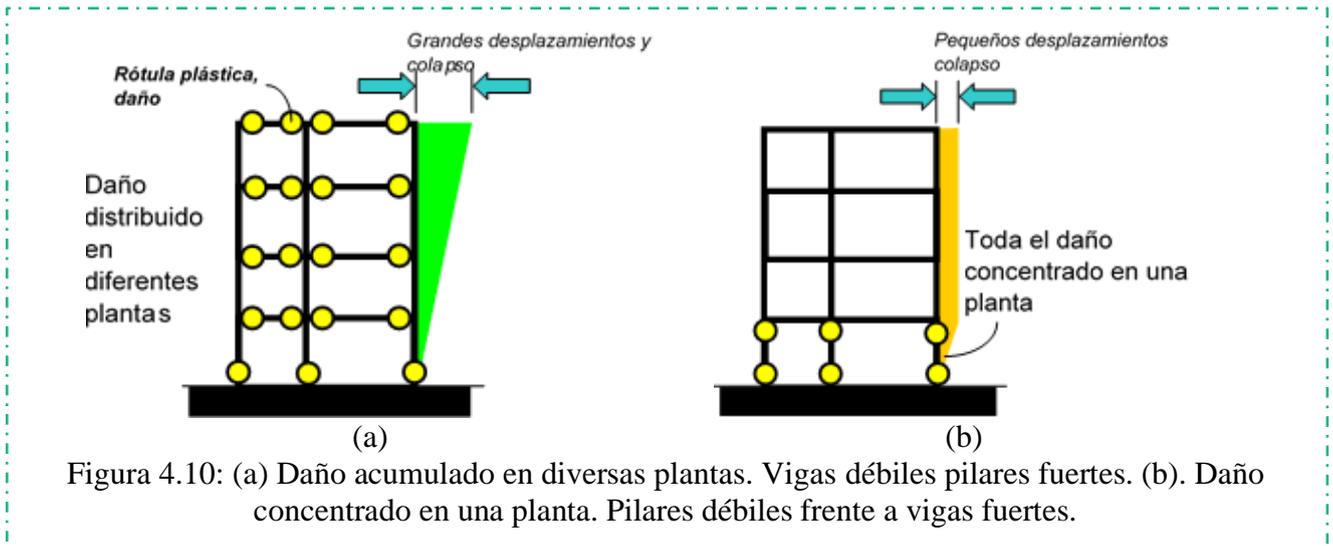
(a) Daño acumulado en diversas plantas. Vigas débiles pilares fuertes. (b). Daño concentrado en una planta. Pilares débiles frente a vigas fuertes.
